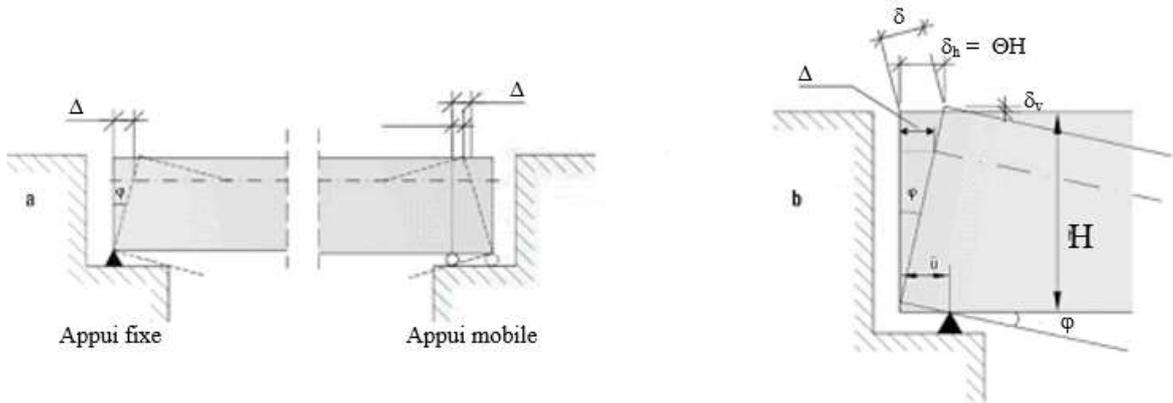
Déplacement horizontal suite à la rotation angulaire
